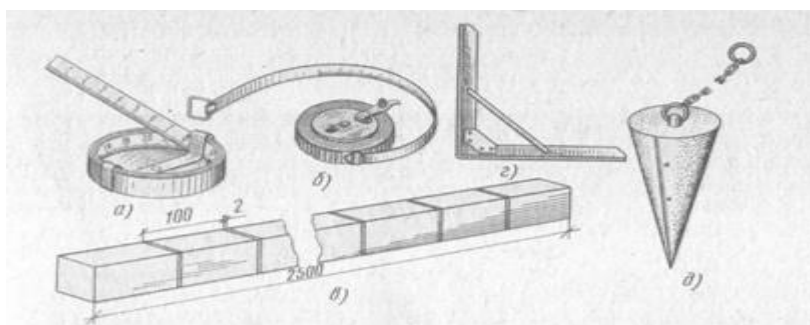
Контрольно-измерительные инструменты и приборы для укладки плиточных полов: а, б — рулетки желобчатая и металлическая в корпусе, в — рейка Болотина, г—металлический угольник, д— эталонный конус
